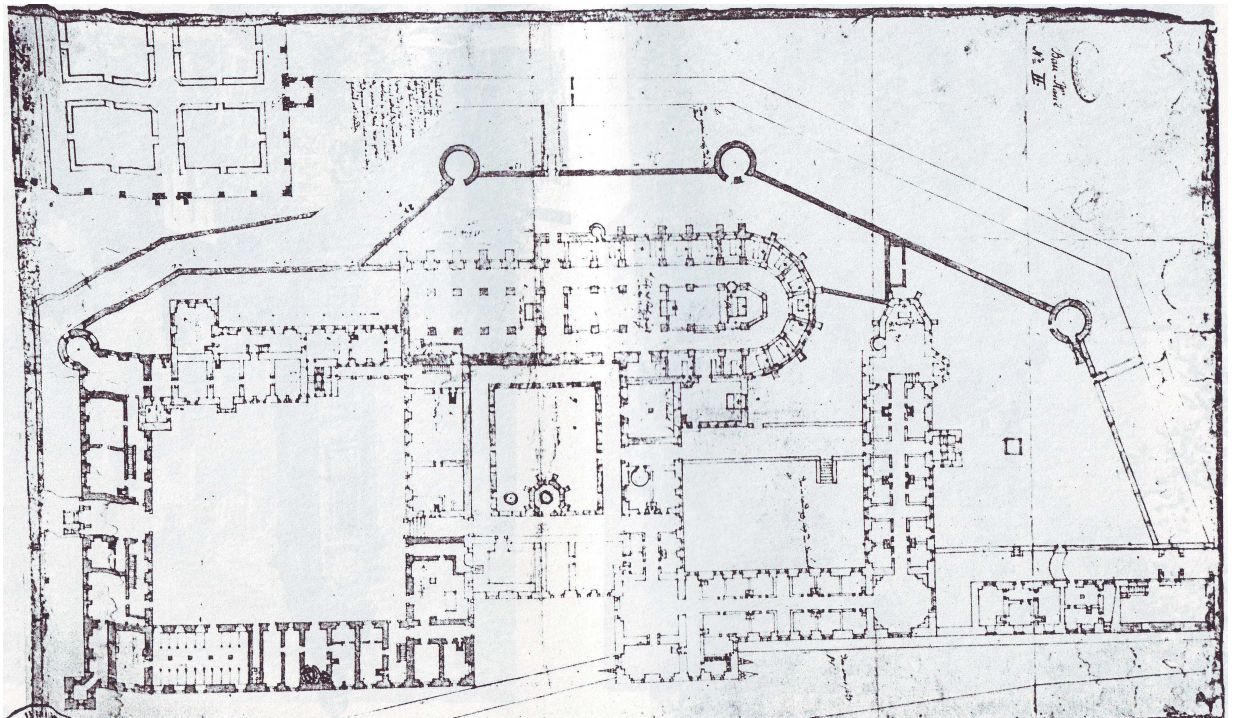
Stift Zwettl, Grundriss des Klosters im Jahre 1650, Baupläne Nr. II.
